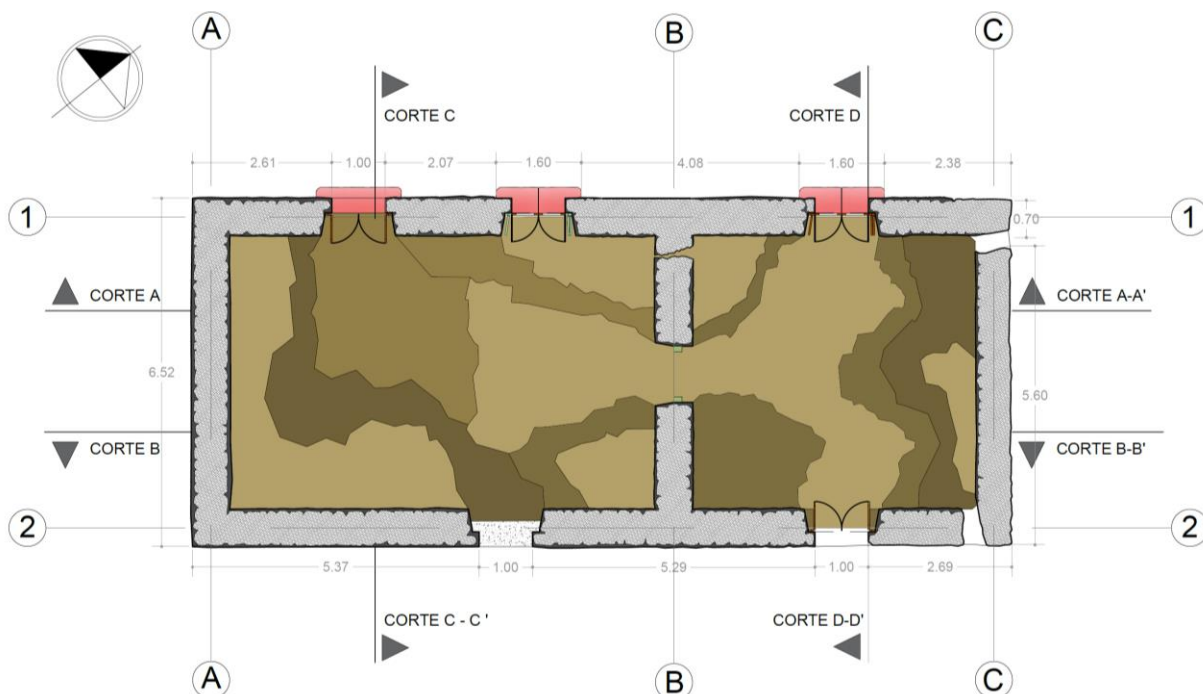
Planta arquitectónica, sin escala. Elaboración propia
